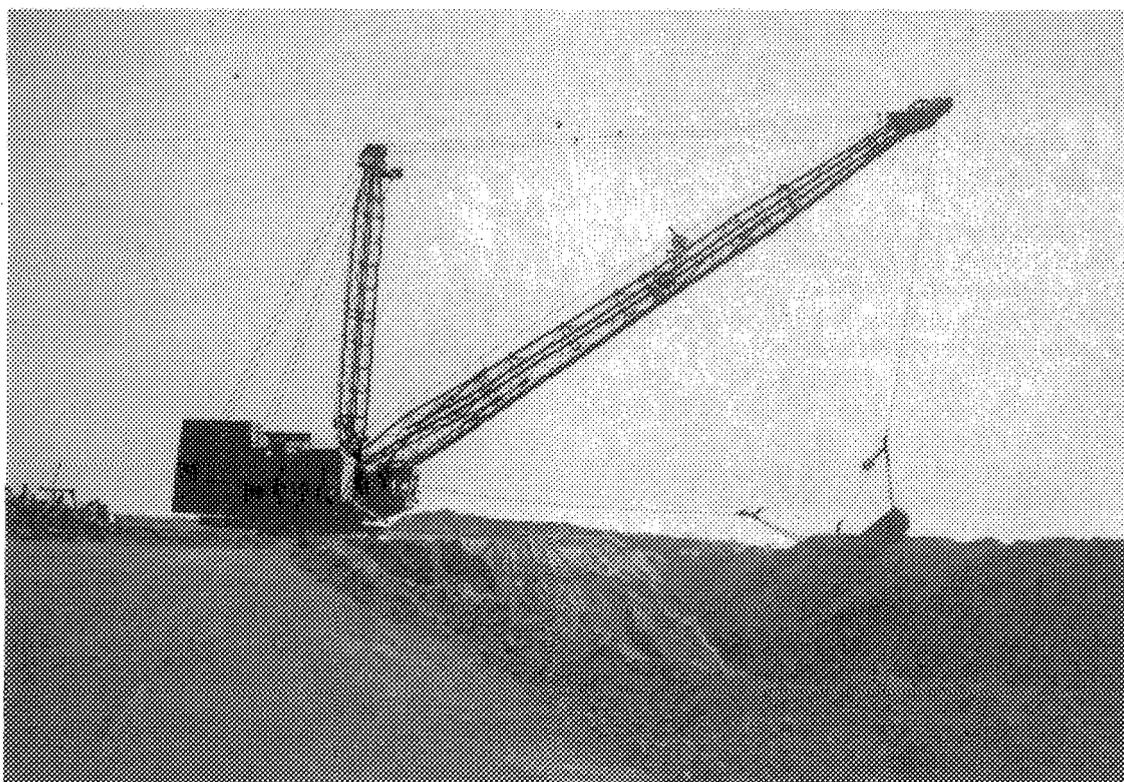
Detalhe da *dragline*, gigantesco equipamento, fazendo a extração, utilizando sua lança de 52m de comprimento e uma çambas de 17 j³ (outubro 1987).
